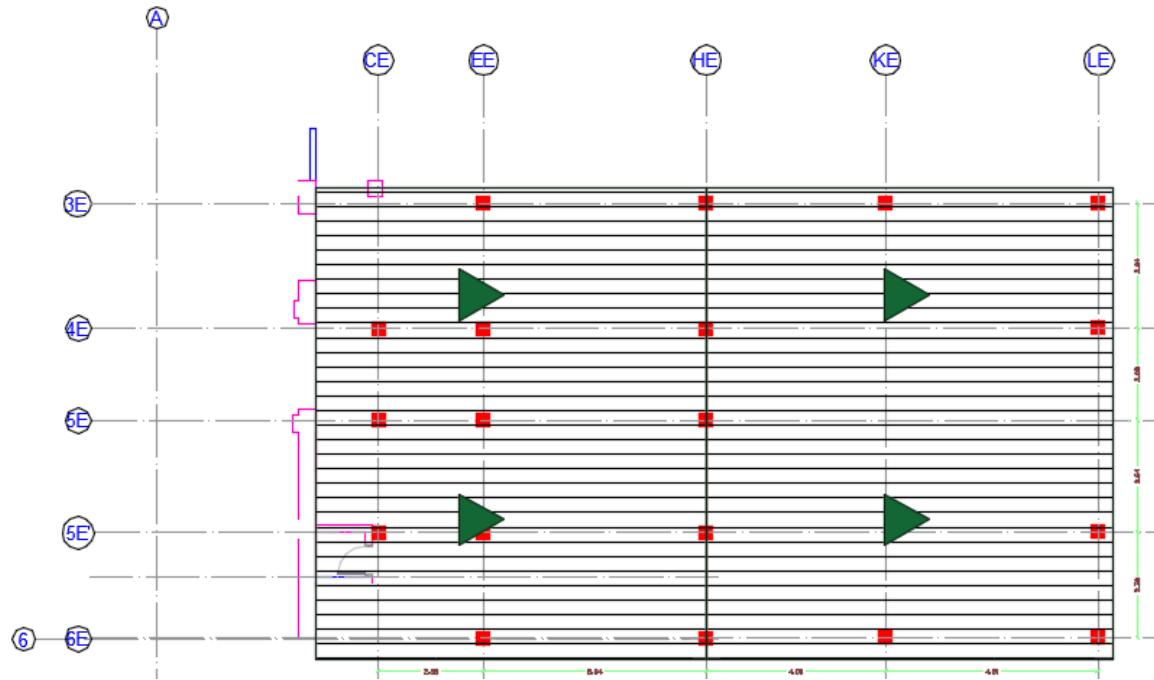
Propuesta de Cubierta a un agua para la Zona A. Fuente: Autor
